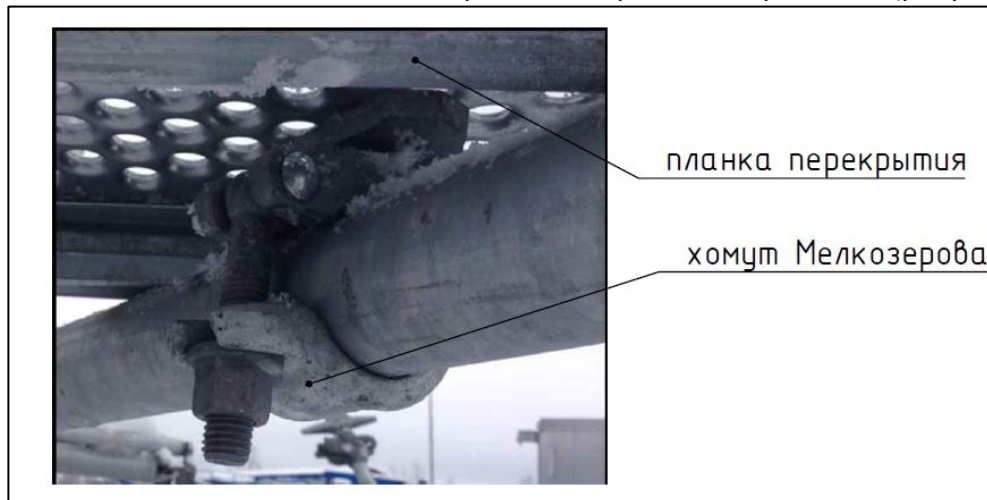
Узел 2. Хомут Мелкозерова и планка перекрытия
